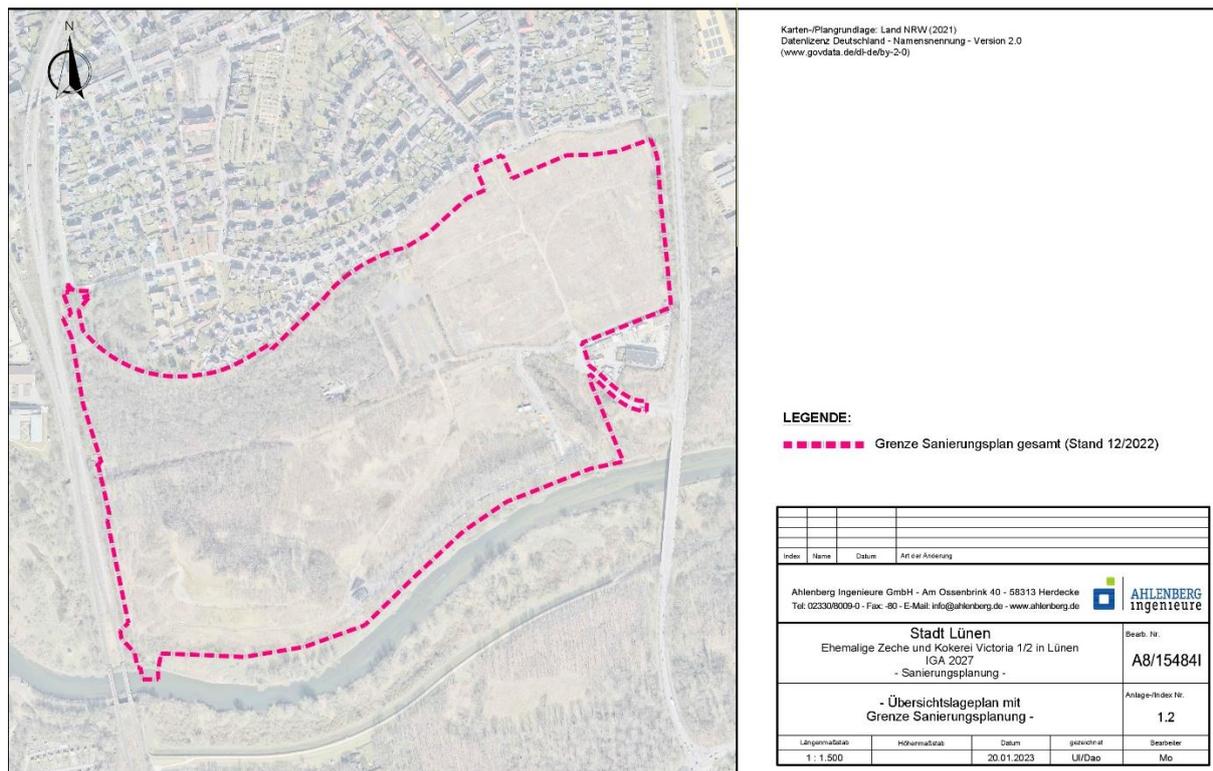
Übersichtslageplan mit Grenze Sanierungsplanung, Stand Dezember 2022, Ahlenberg Ingenieure GmbH;
